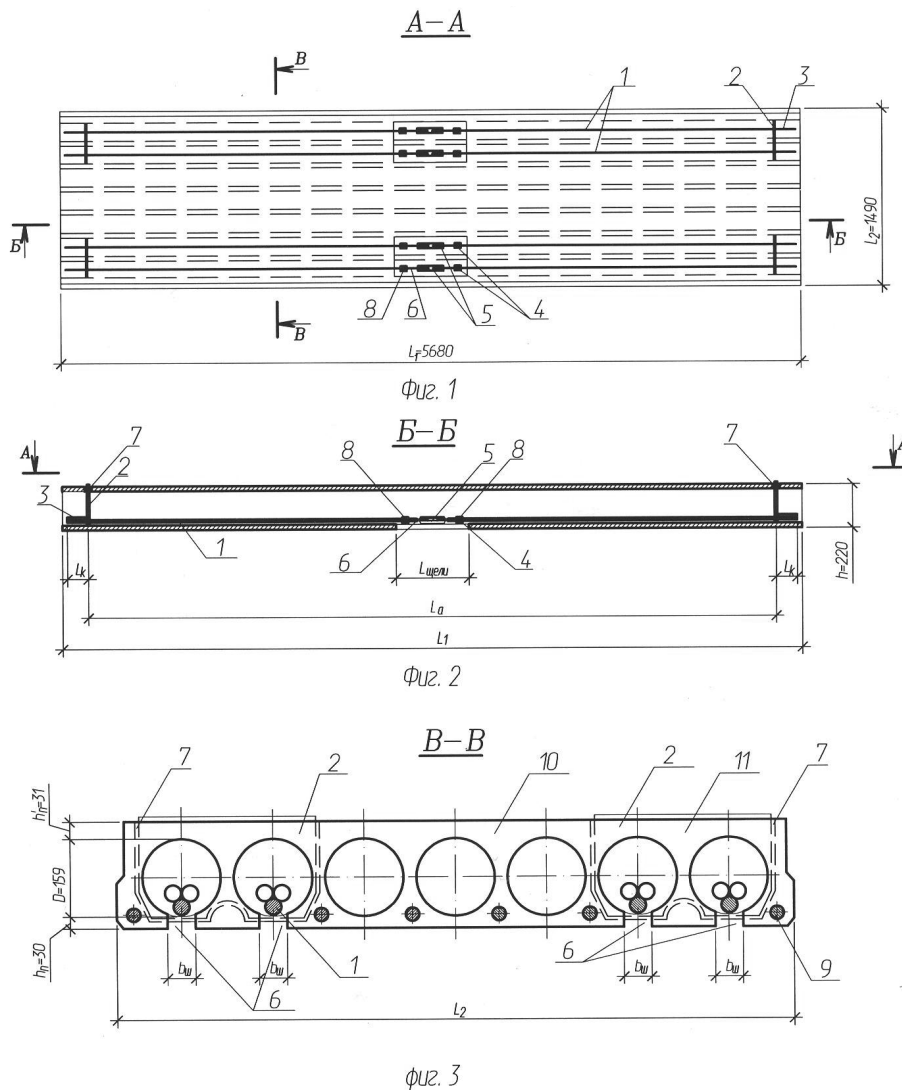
Схема армирования усиленной многопустотной панели перекрытия: сечение А-А – план (фиг. 1); сечение Б-Б – продольный разрез (фиг. 2); сечение В-В – поперечный разрез (фиг. 3)
